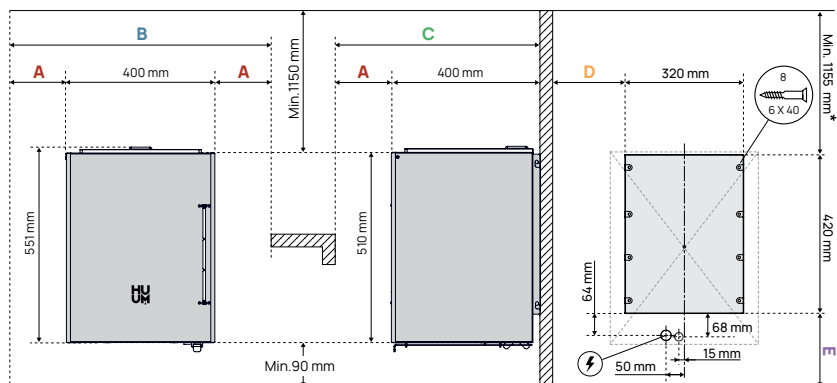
Posizionamento di CORE Wall Combi HUUM.
